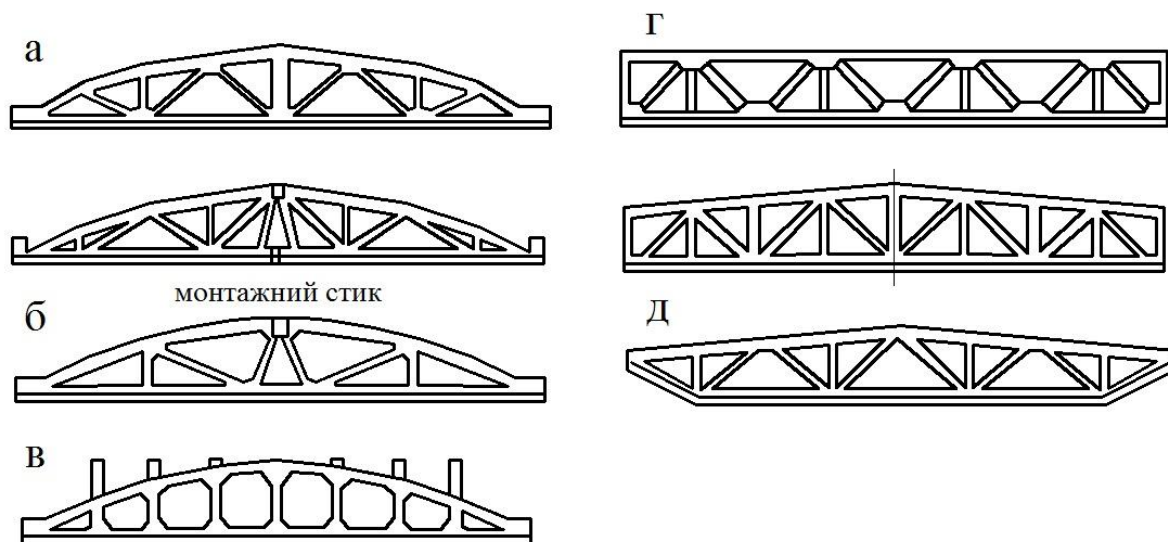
Конструктивні схеми залізобетонних ферм
